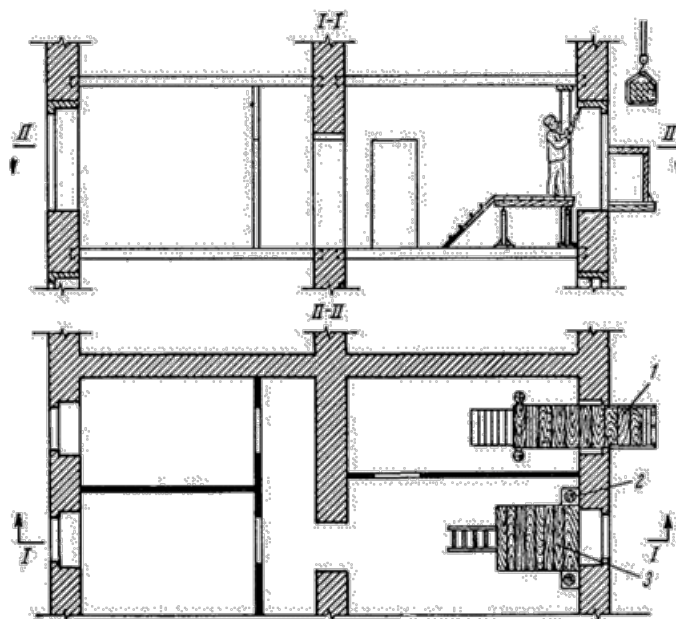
Общая схема организации работ по замене кирпичной перемычки сборной железобетонной
